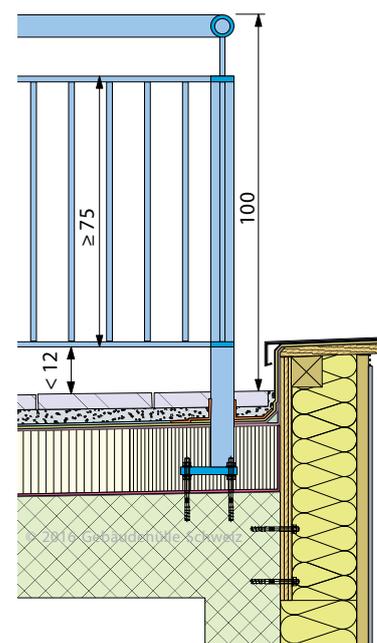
Hauteur des éléments de protection. Parapet d'au moins 90 cm dans cette exécution. Recommandation bfu: Hauteur min. 100 cm
